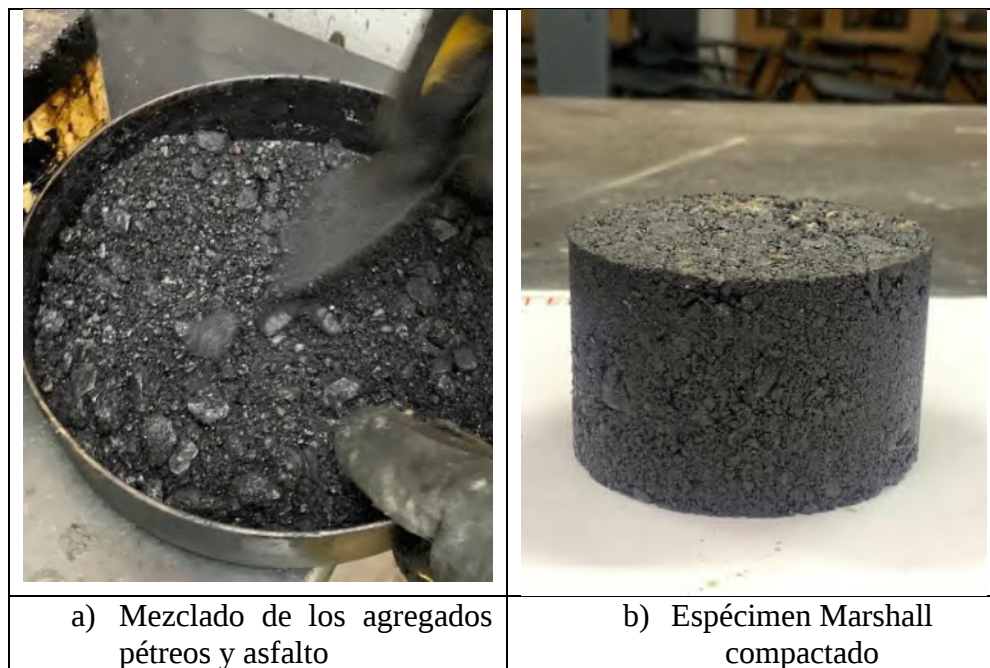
Mezclado final para la elaboración del espécimen Marshall.
